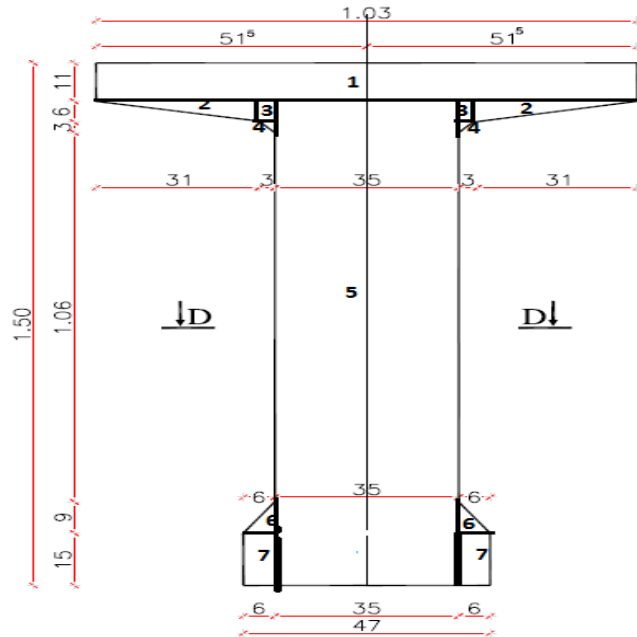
Section intermédiaire de la poutre intermédiaire sans hourdis.
